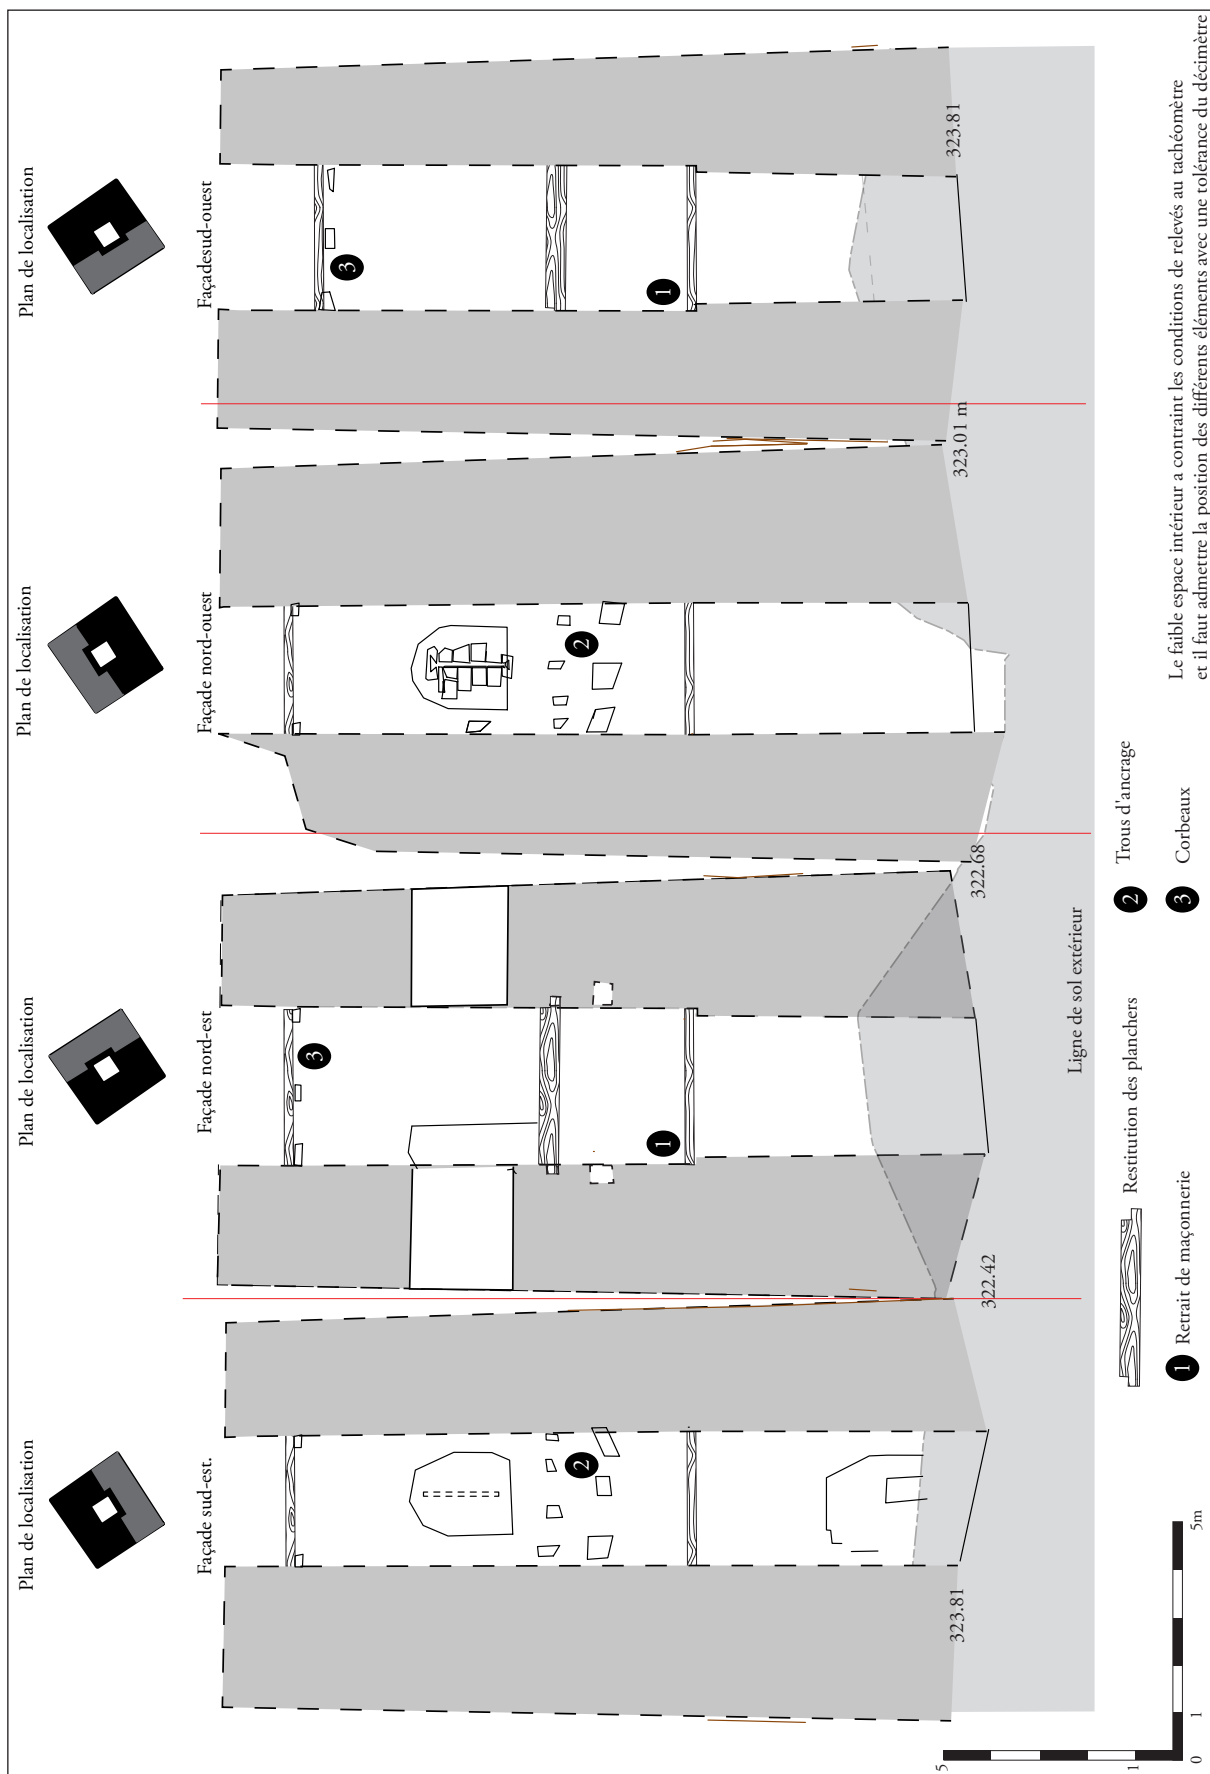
Déroulé des façades intérieures avec emplacement des niveaux de planchers
